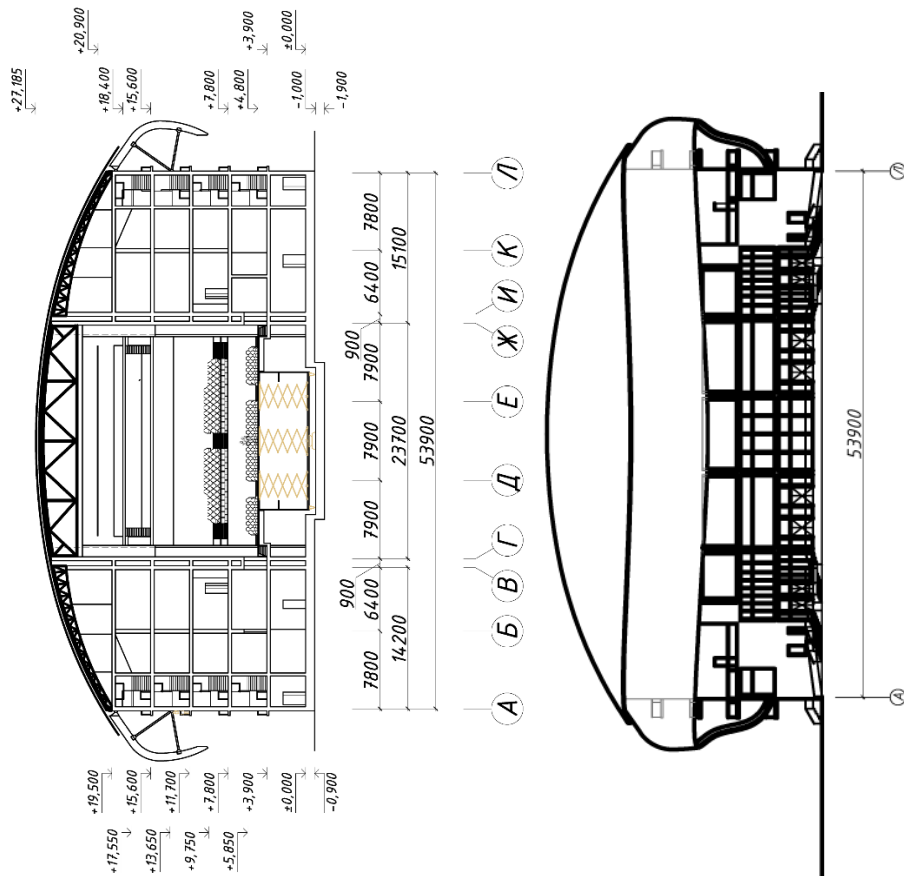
Схема: а – поперечний переріз; б – фасад по вулиці Ливарна.
